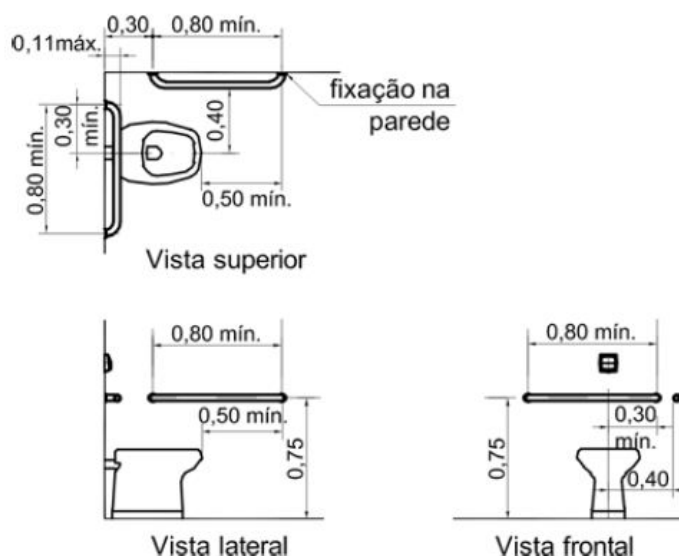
Barras de apoio lateral e de fundo em bacia sanitária.
